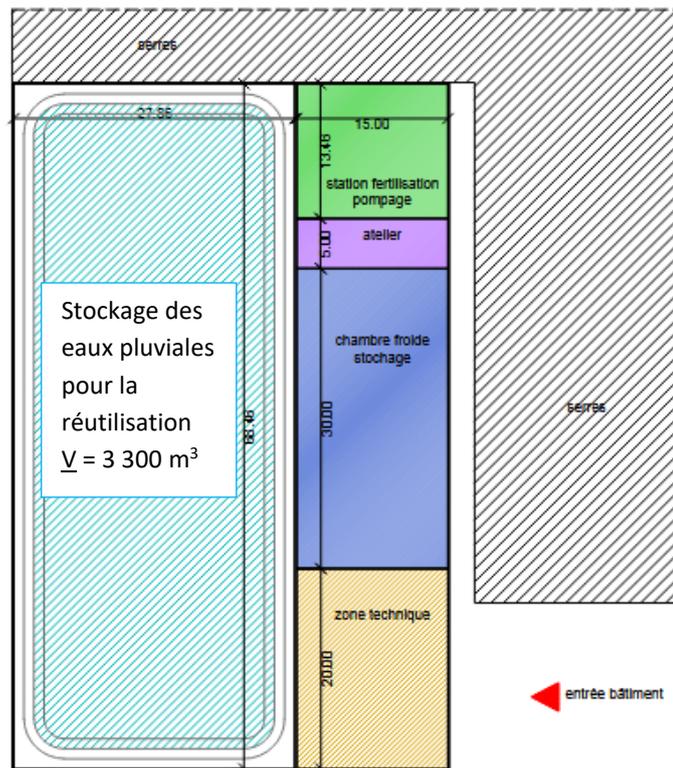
Plan d'implantation des ouvrages de rétention par rapport aux serres-chapelles
